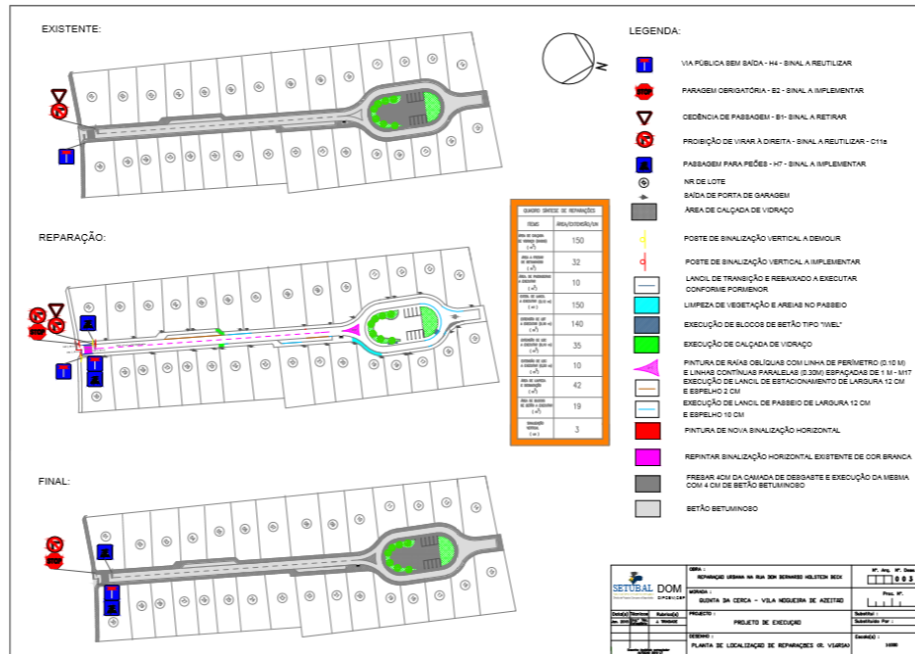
Planta de reabilitação da sinalização vertical e horizontal
